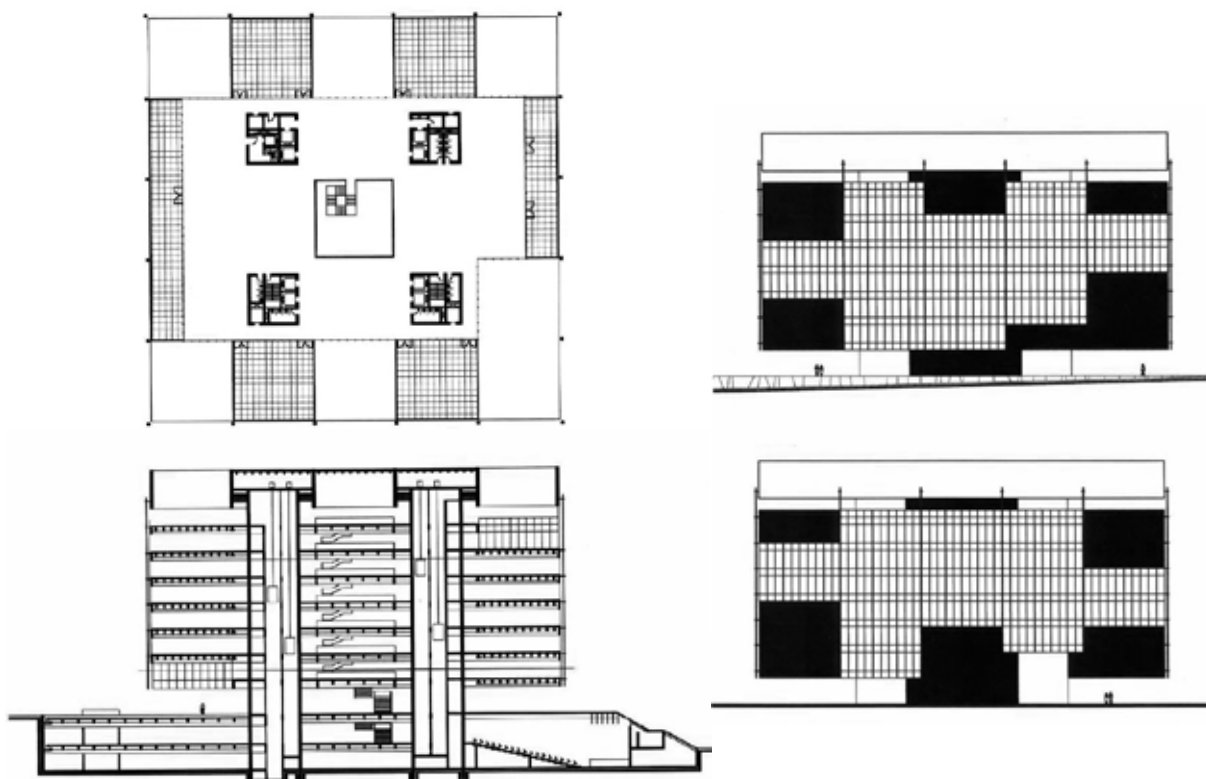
1º prêmio BNDE DF; planta 7º pavimento, reservado para a associação dos funcionários.
